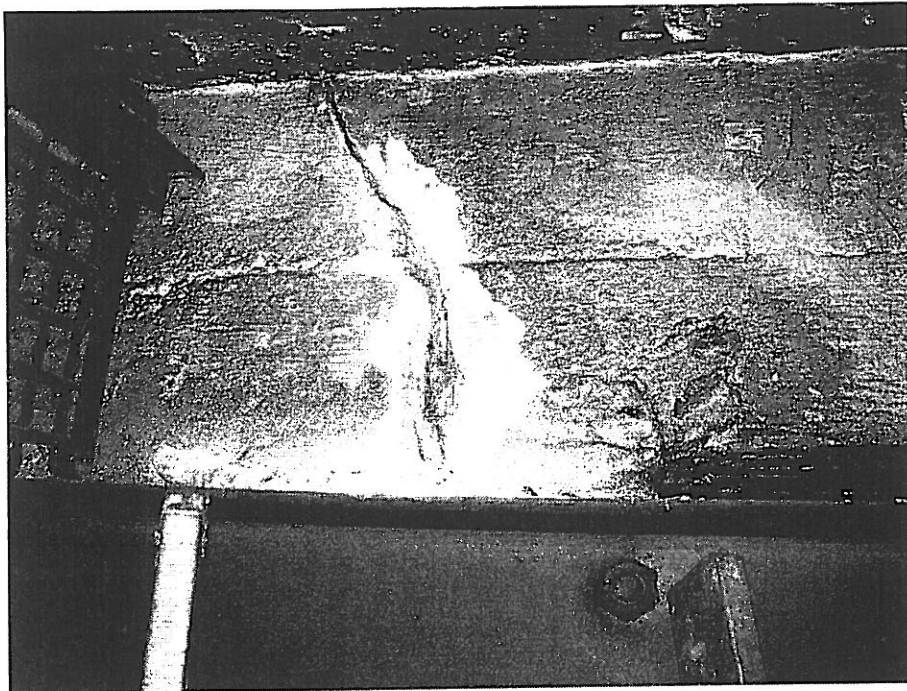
Rozwarstwienie żelbetowej belki stropodachu w poziomie styku z ceramiczną płytą
